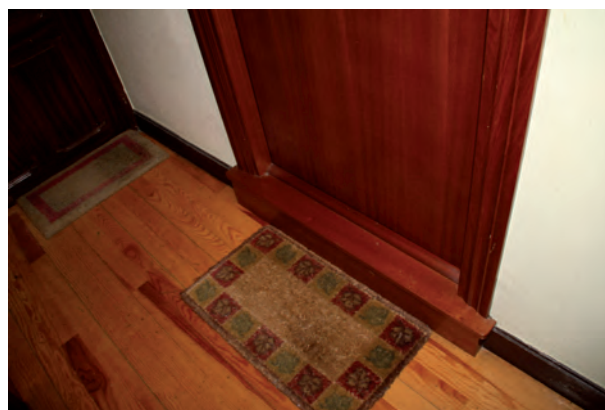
56. ESCALÓN DE ACCESO A VIVIENDA
